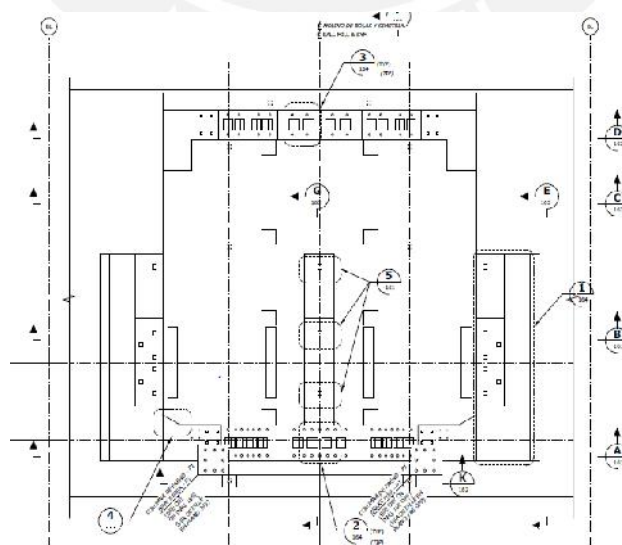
Vista en planta del elemento estructural Molino Bolas 02.
